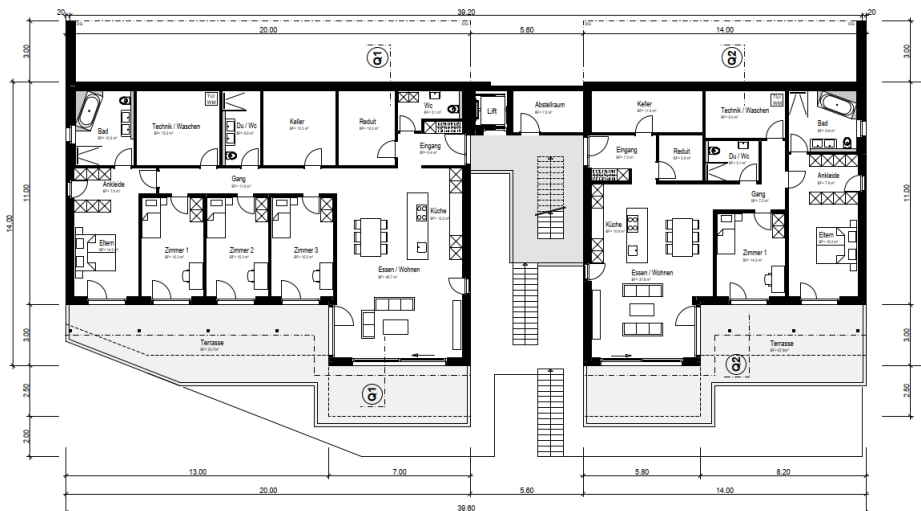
Richtprojekt: Ausschnitt Grundriss 1. Obergeschoss
